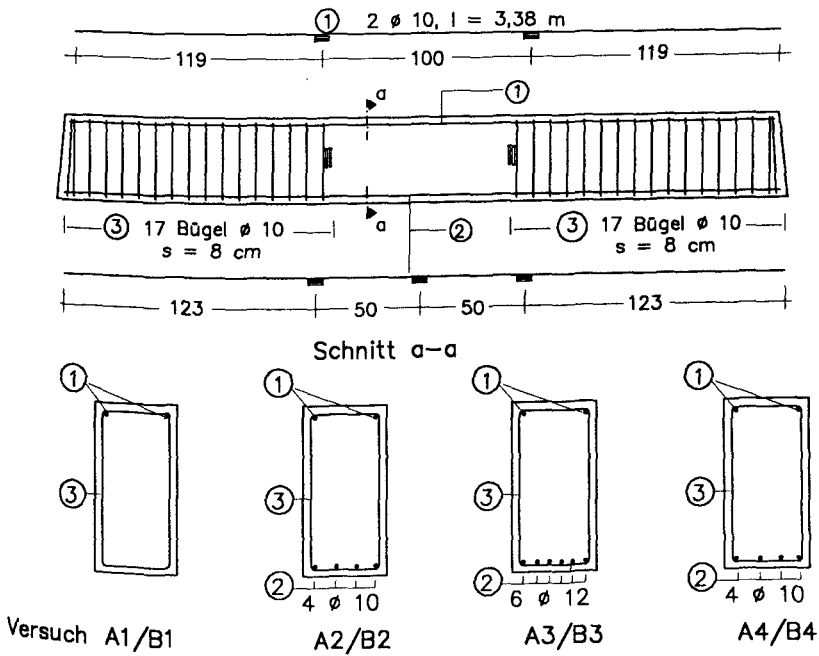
Betonstahlbewehrung mit Stahleßstellen
